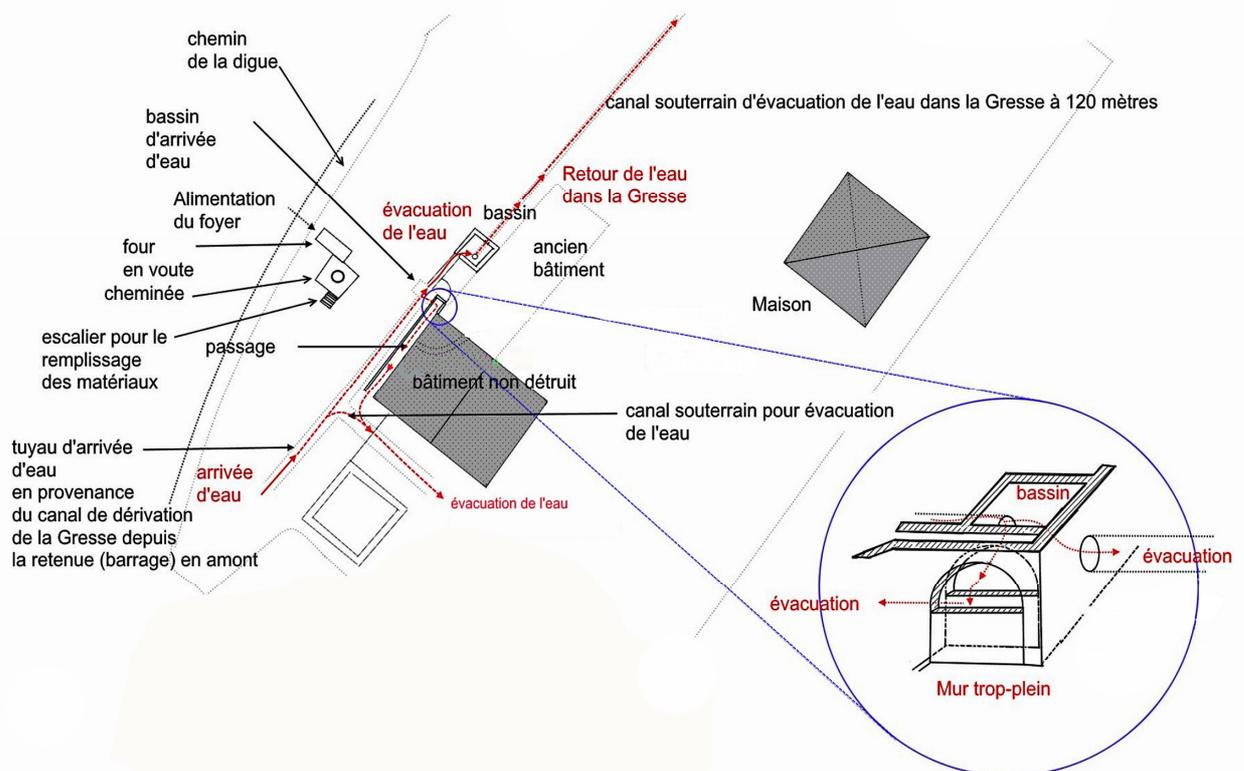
Plan du site montrant les différents éléments techniques subistants. Le croquis à droite montre le système de trop plein permettant de diriger l'eau du canal soit dans le bassin, soit dans le conduit longeant le bâtiment.
